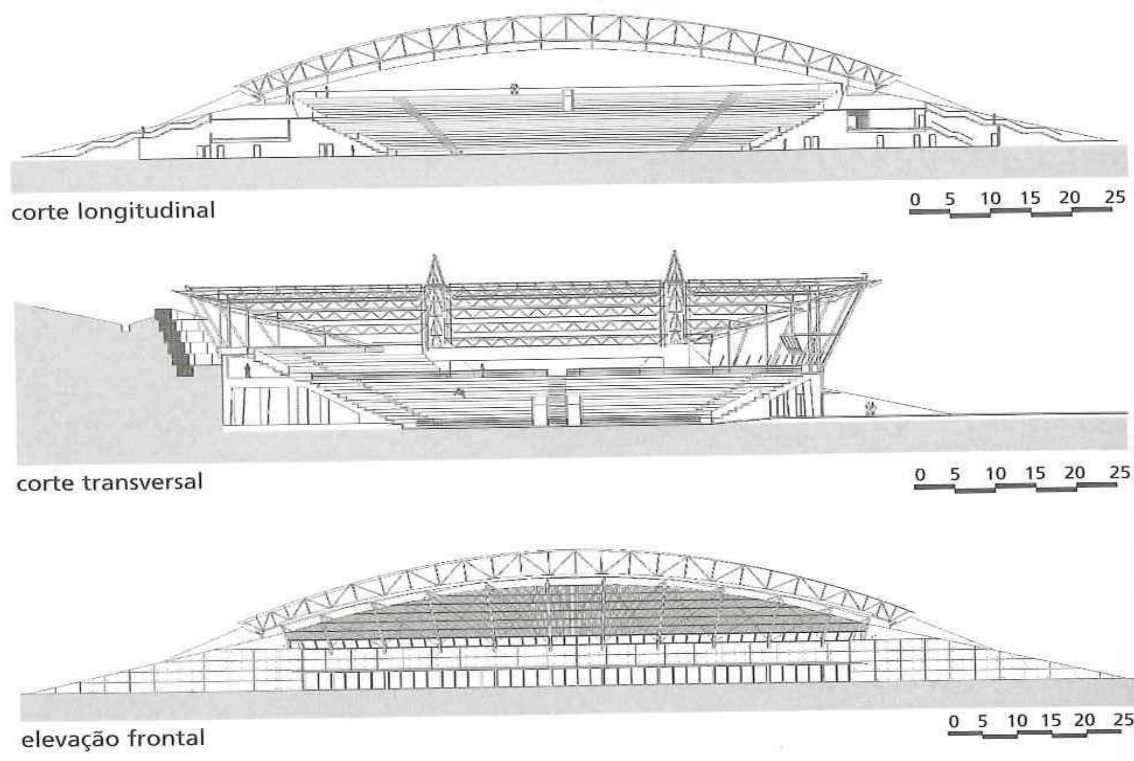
Cortes e elevação do projeto do Ginásio de Barueri.
